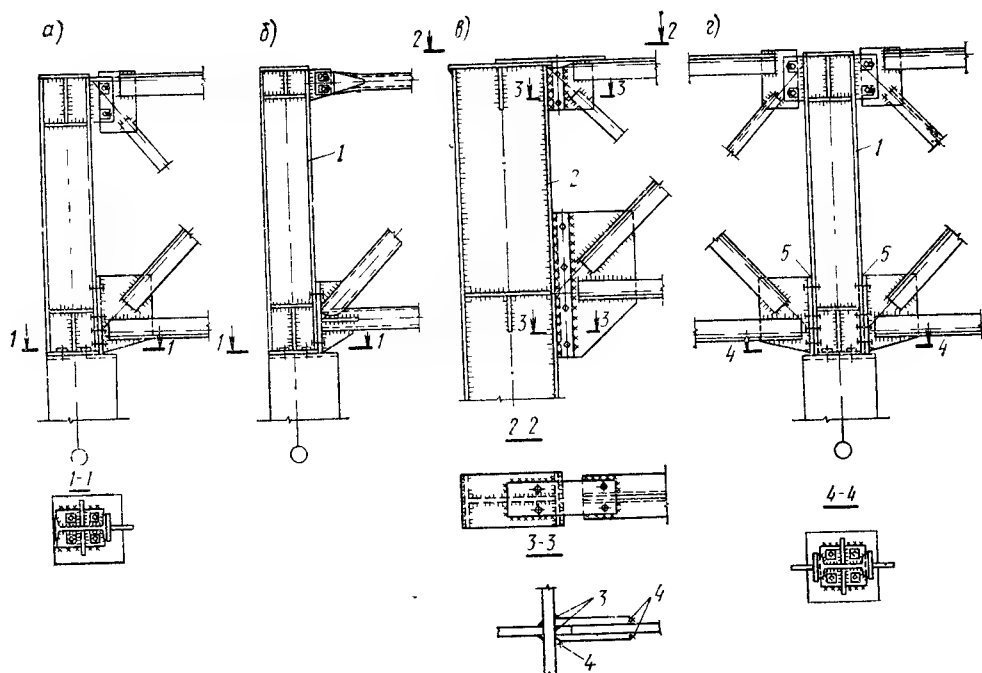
Узлы сопряжения стропильных ферм с колоннами
